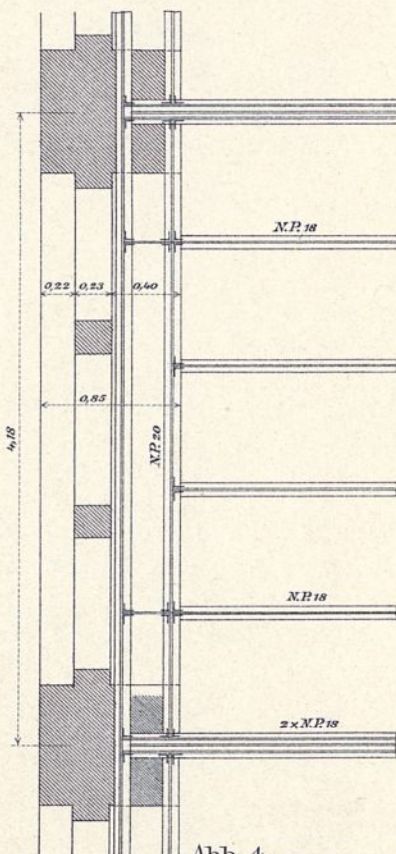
Fenstergrundriß mit eisernen Deckenbalken im Speicherbau.
